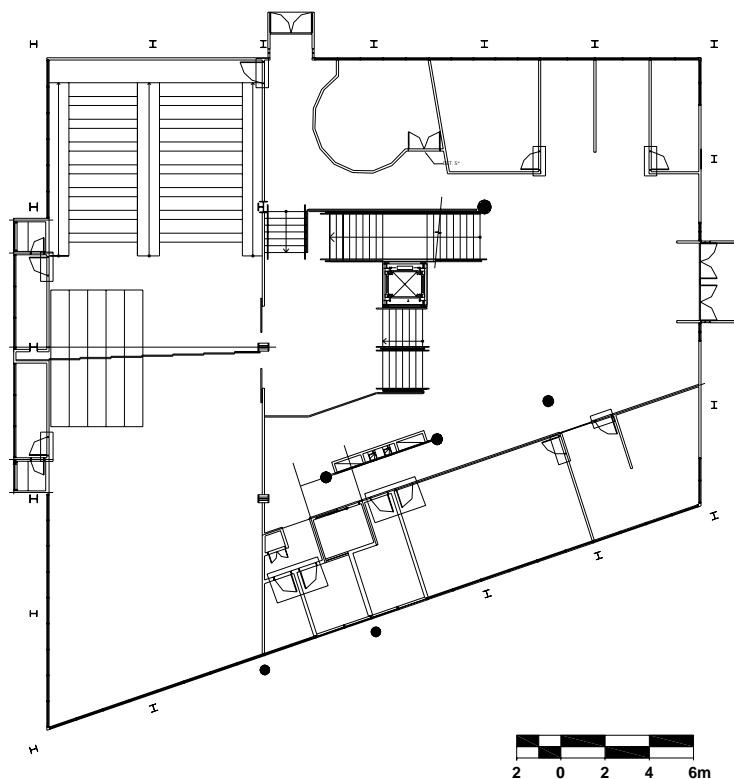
Planta baixa do pavimento térreo que compõe o projeto de alvenaria do Edifício LCT
